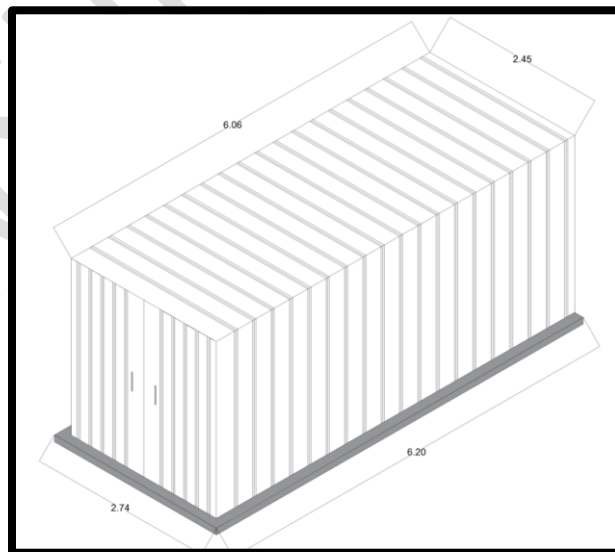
Plataforma de concreto y contenedor de planta desalinizadora y tanque de re mineralización
